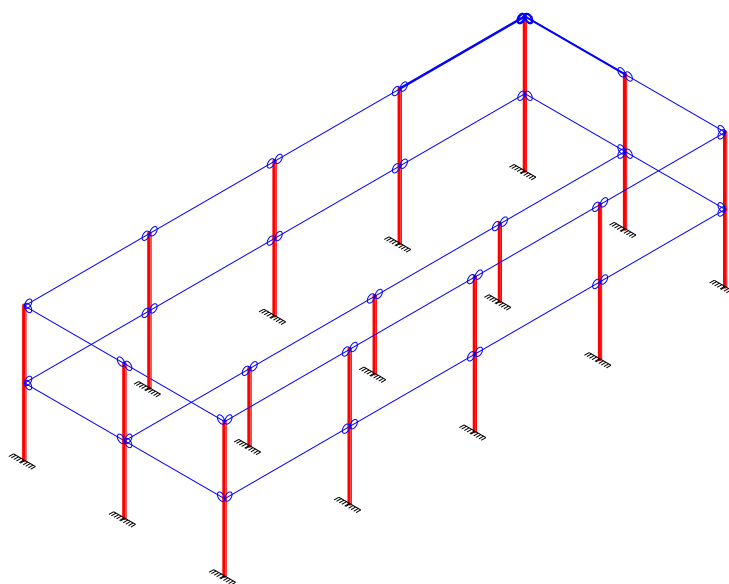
5 – Esquema estrutural espacial da estrutura indicada anteriormente.
